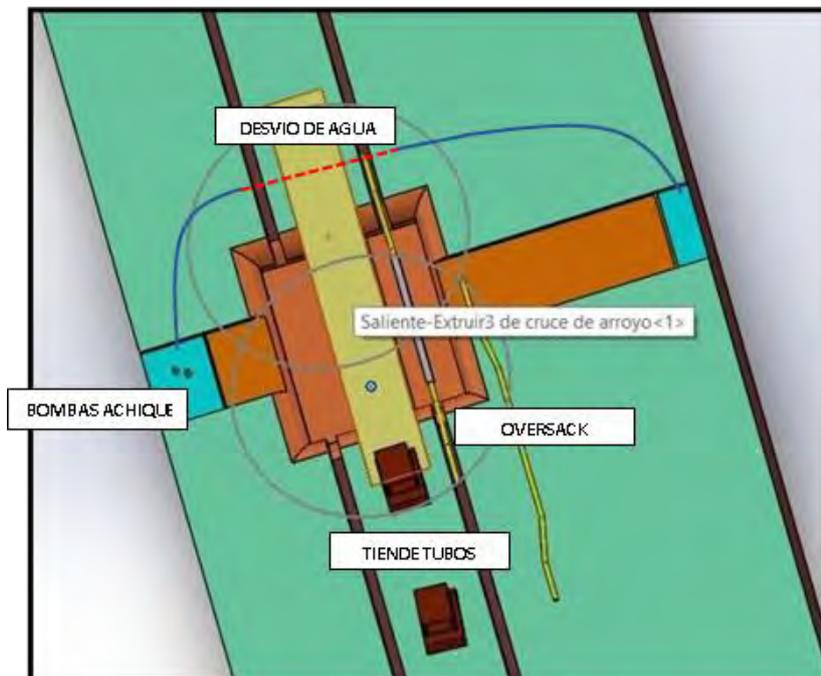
Detalle cruce arroyo Pareja (rectificado)
